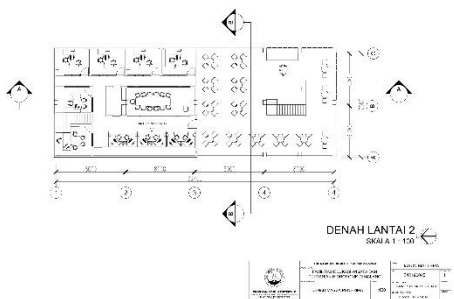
Denah Lantai 2 Massa Edukasi
